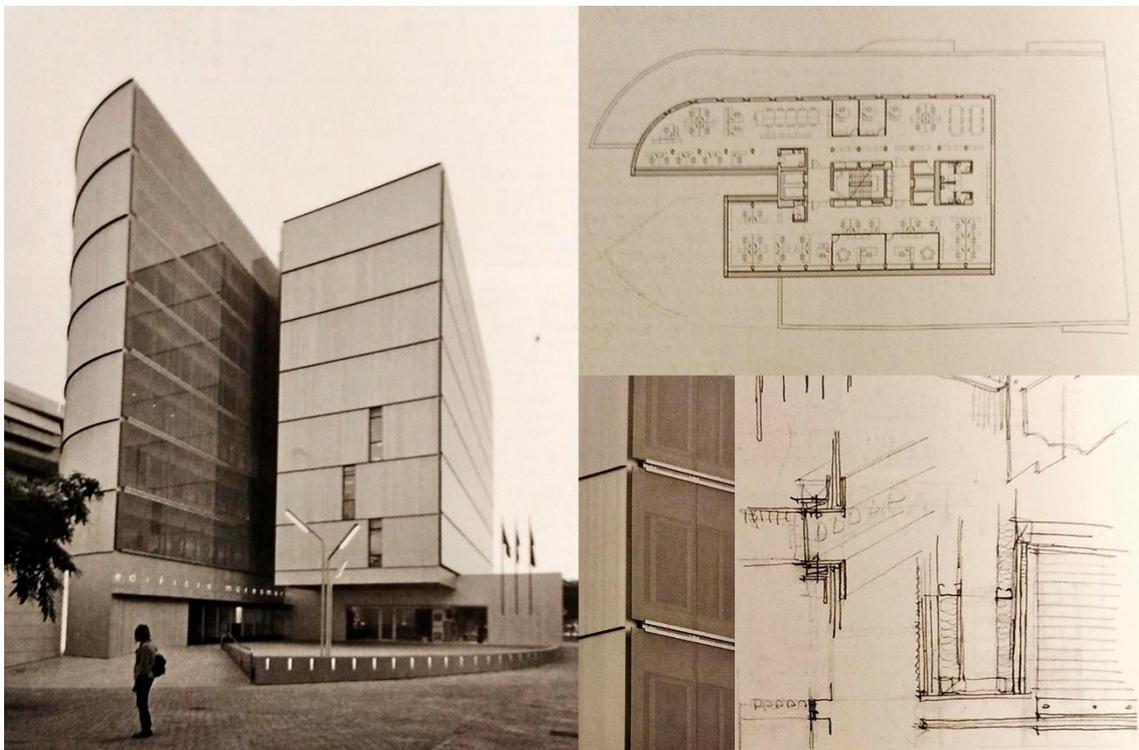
Fachada exterior de acceso, planta, detalle elemento protección solar y croquis constructivo carpinterías.
